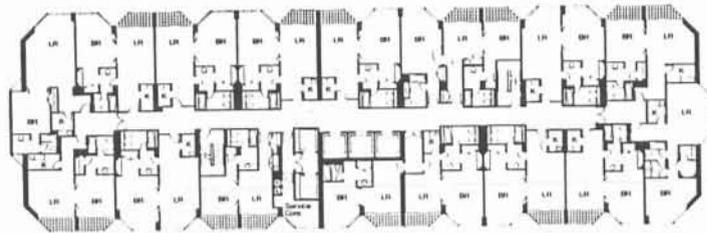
Windsor Court, Morris Aubry, New Orleans - LA. Planta Baixa.
